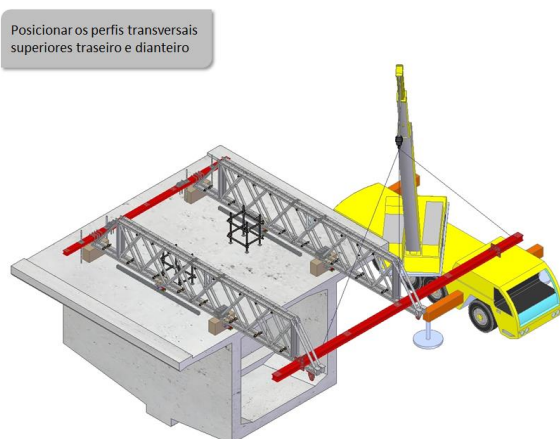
Posicionamento de perfis transversais superiores
